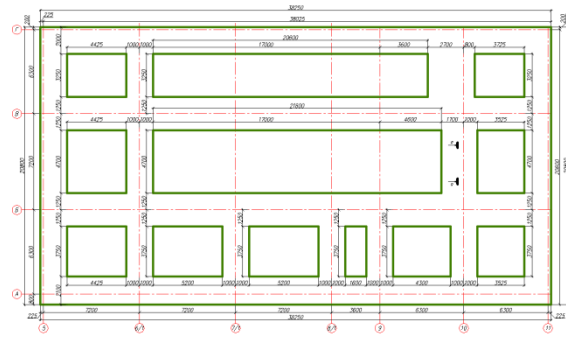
Опалубочный план фундаментных перекрестных лент
